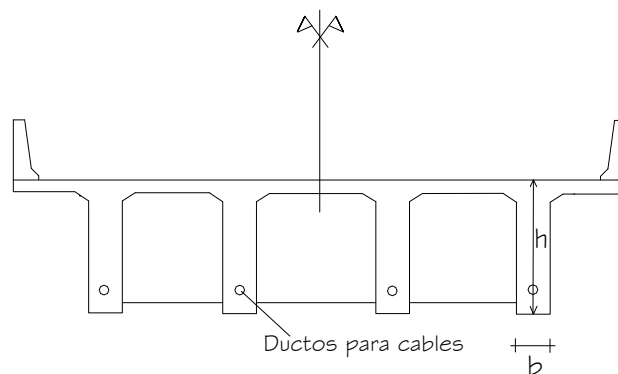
Sección transversal de un puente con vigas presforzadas
